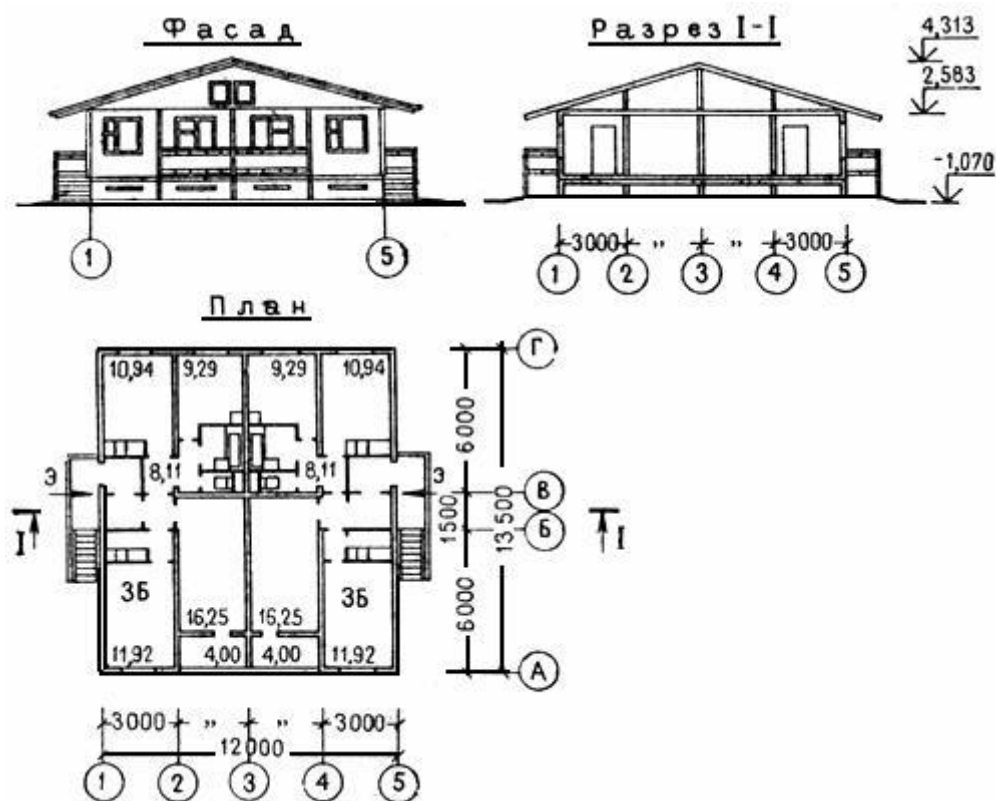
Двухквартирный жилой дом с двумя трехкомнатными квартирами жилой площадью 39,11 м и общей площадью 66,15 м . Типовой проект 420-10-1 (к цене N 2)
